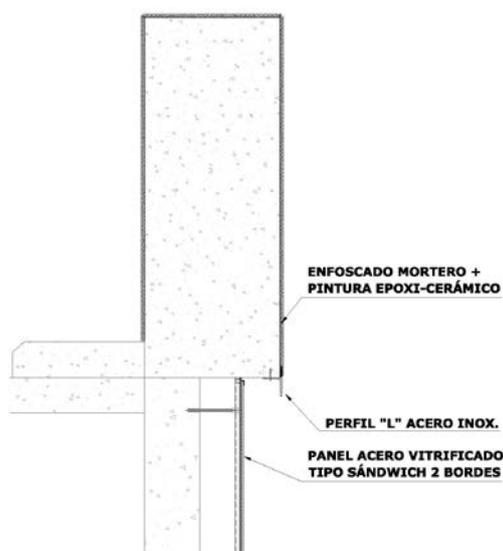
Detalle de remate de arista con perfil “L” de acero inoxidable
